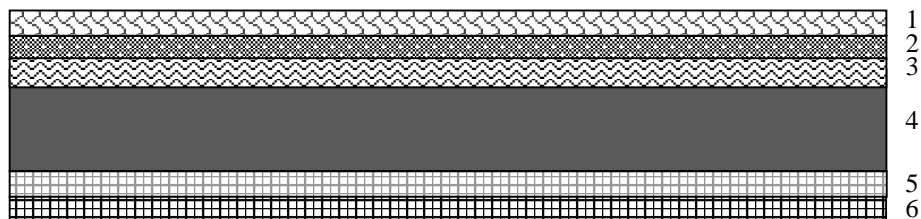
Coupe verticale du plancher courant à dalle pleine.
